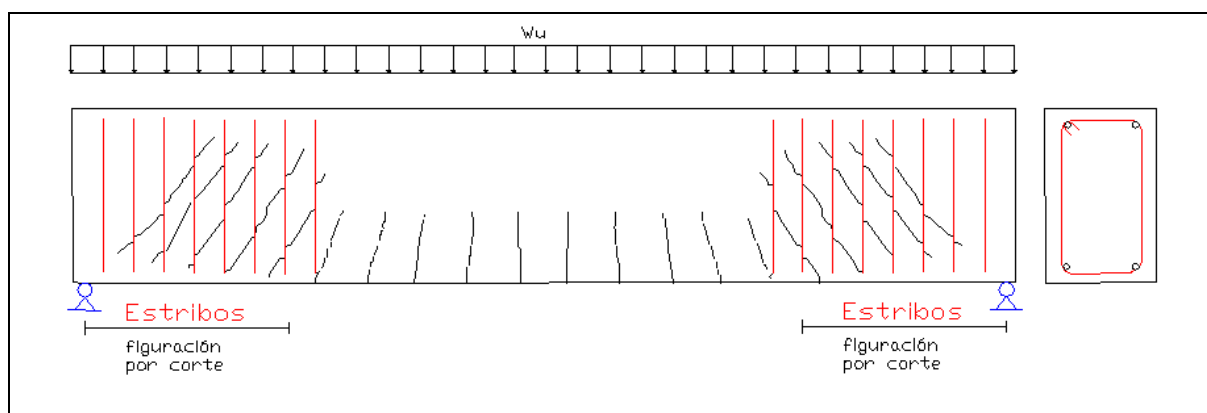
Ubicación de estribos según grietas de tensión diagonal
